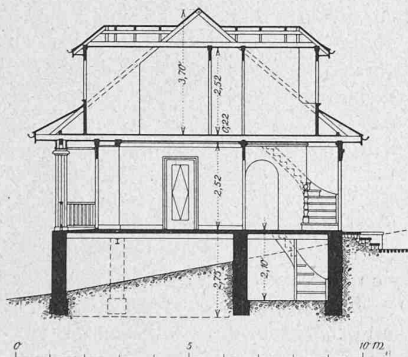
bis 3. Grundrisse und Schnitt 1 : 200. — Abb. 4. Konstruktions-Details 1 : 20.
